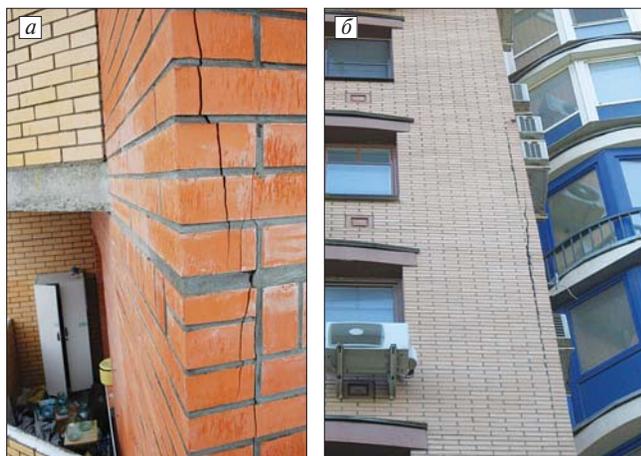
Трещины в облицовке фасадов наружных многослойных стен многоэтажных жилых зданий. Вертикальные и горизонтальные деформационные швы не предусмотрены проектами: а – ширина раскрытия трещины до 5 мм (Московская область, г. Истра); б – трещина до 30 мм (Москва, ул. Старослободская)
